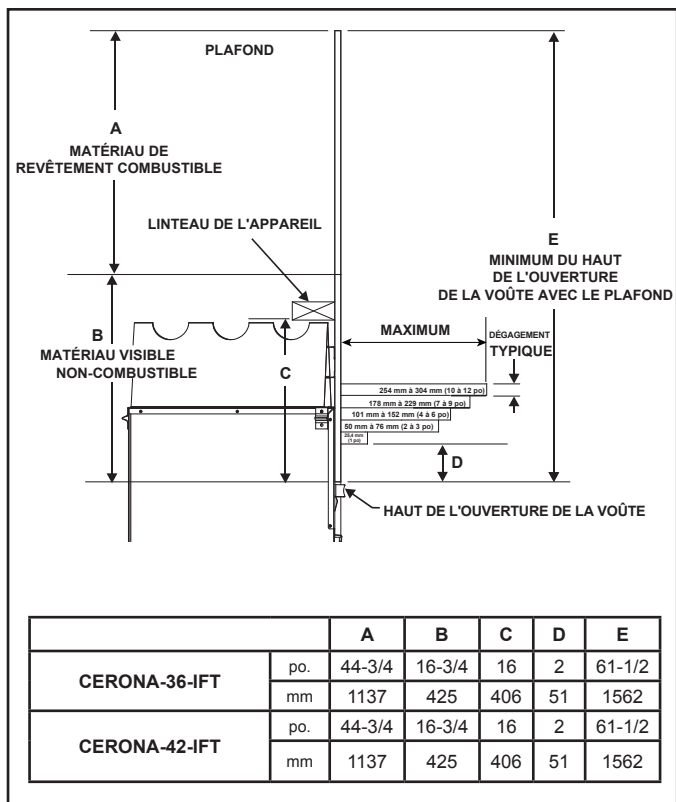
Dégagements par rapport aux manchons ou autres matériaux combustibles au-dessus de l'appareil avec chaleur passive installée
